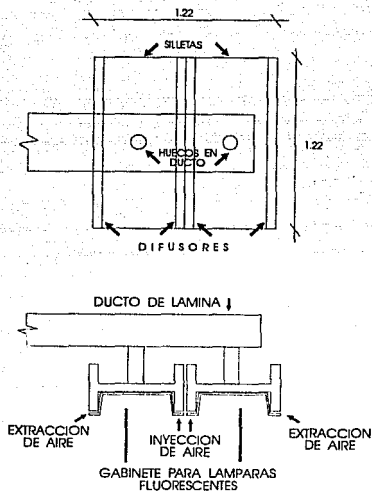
DETALLE EN PLANTA Y EN CORTE DE LOS DIFUSORES DE AIRE (SILLETAS)
